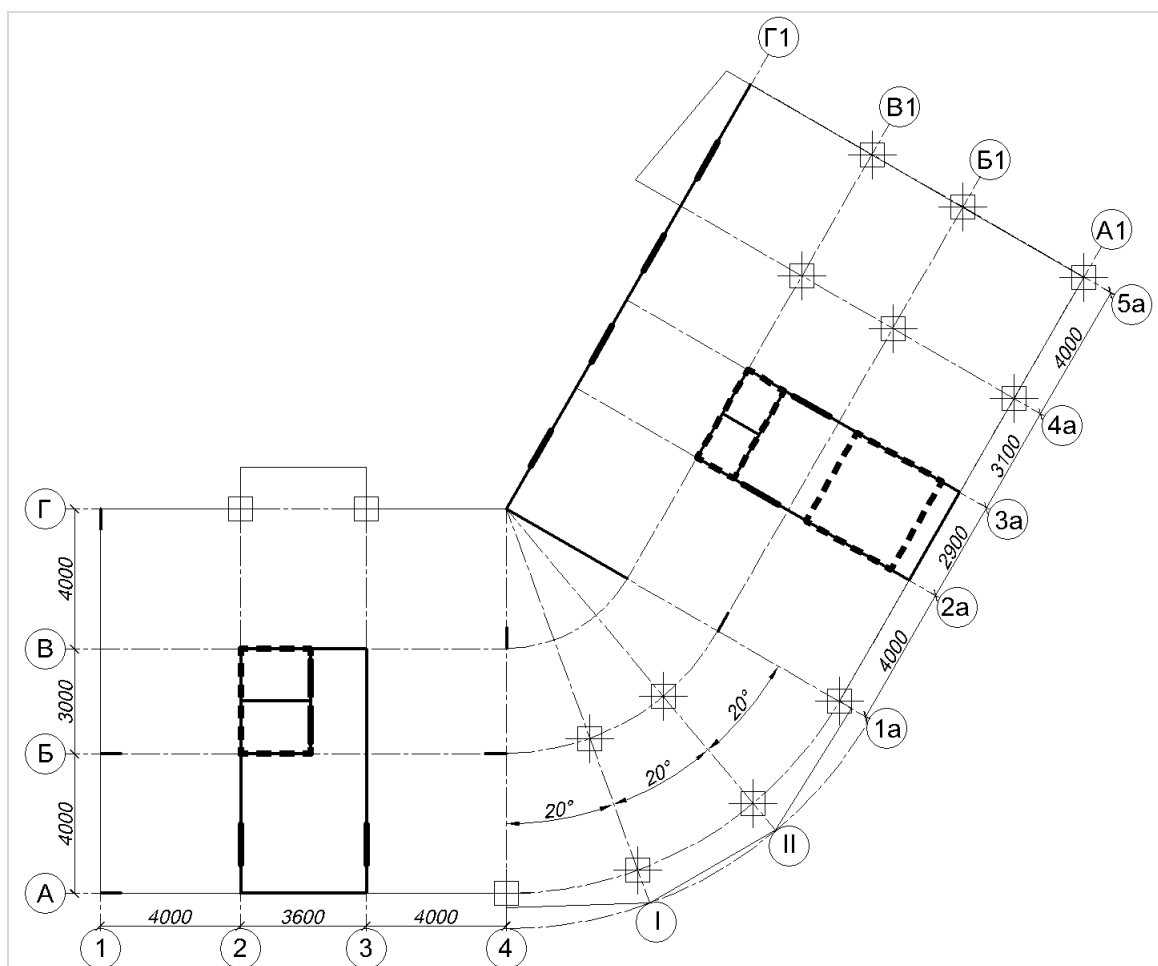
Плита перекрытия типового этажа с отверстиями
